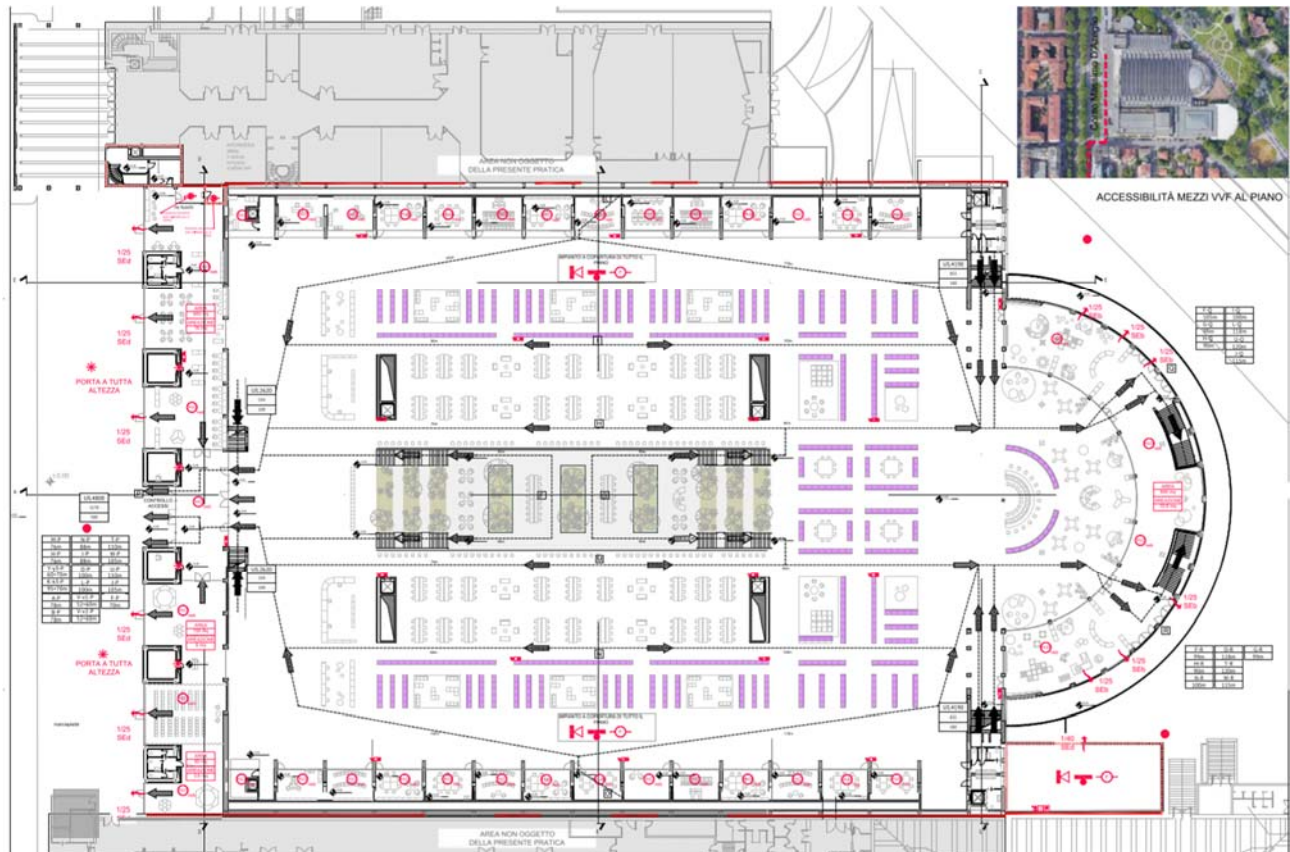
Progetto di prevenzione incendi - Pianta Piano Terra
